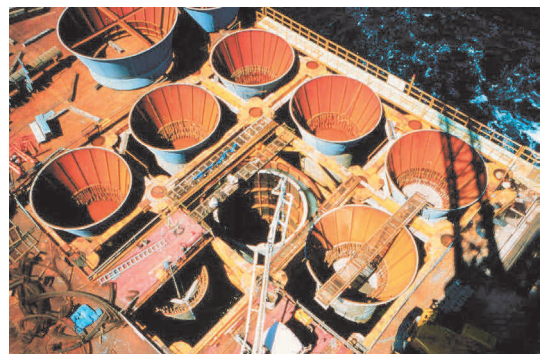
海上足場及び多柱基礎鋼管（大鳴門橋）
